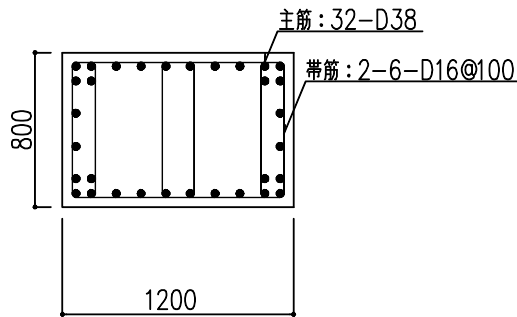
柱の配筋図 (地下2階, X34/YC 通り, 柱脚部) (単位: mm)
